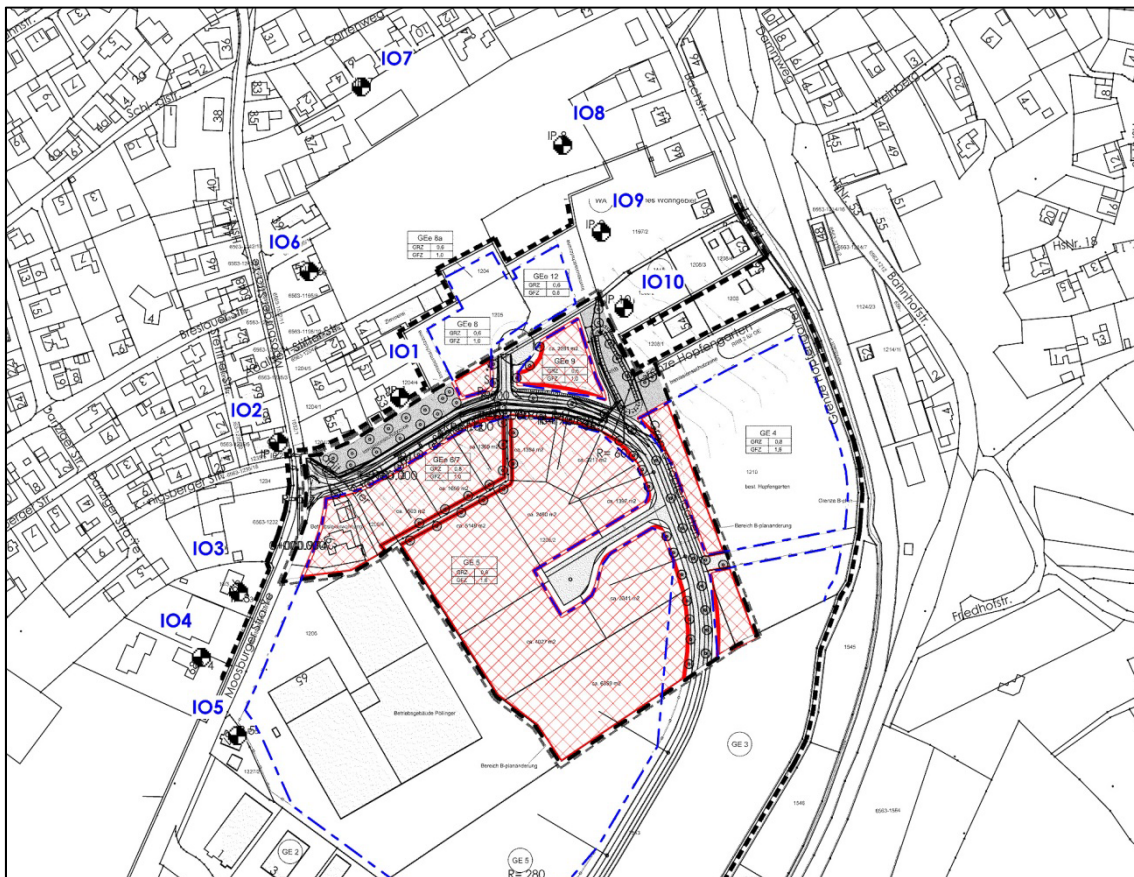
Lageplan mit Eintragung der maßgeblichen Immissionsorte
